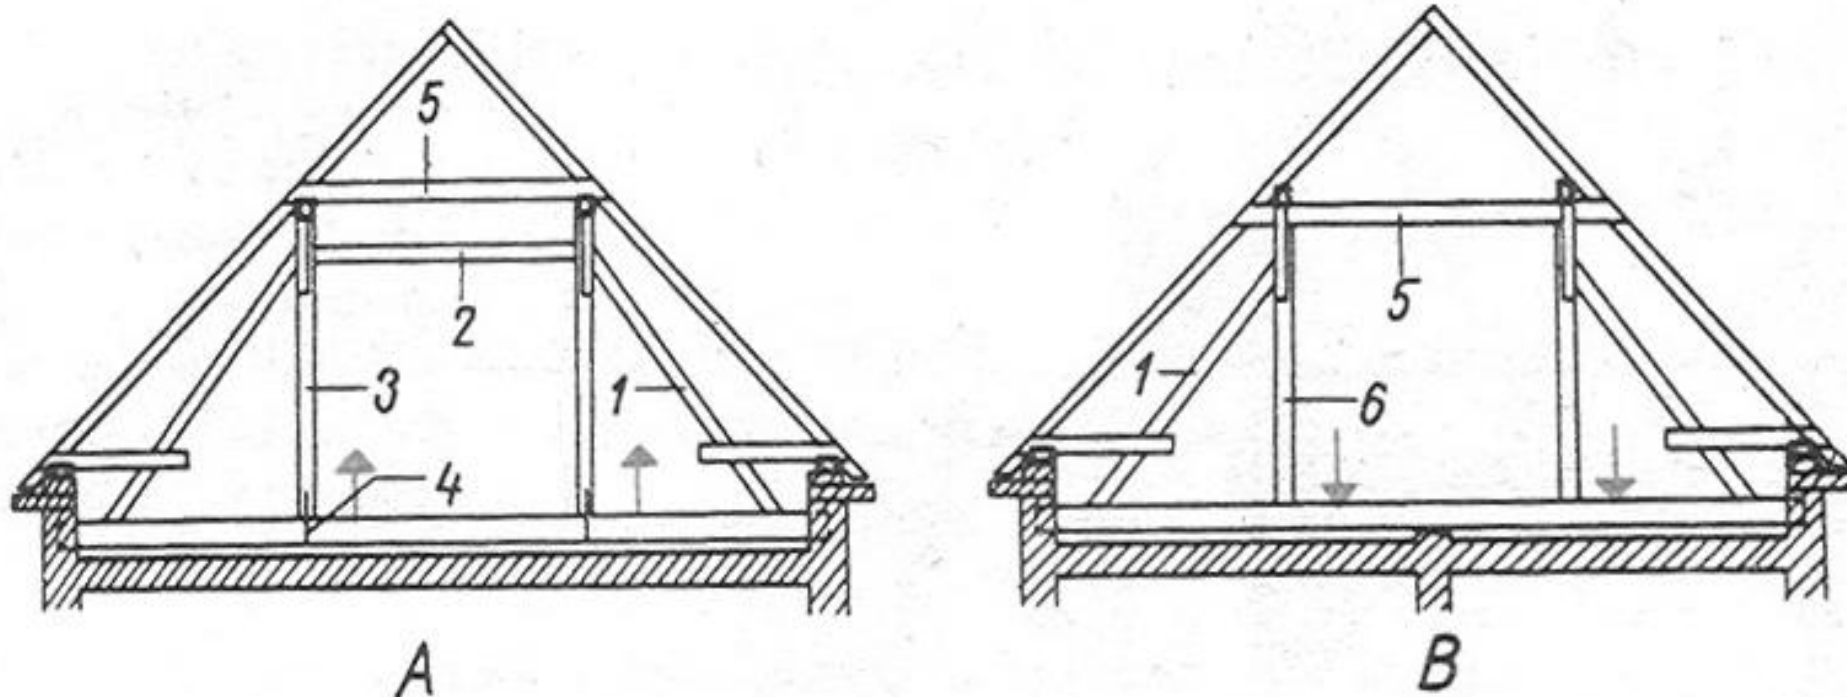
Konstrukce zastřešení Ardantovy soustavy na rozpon 30 m
